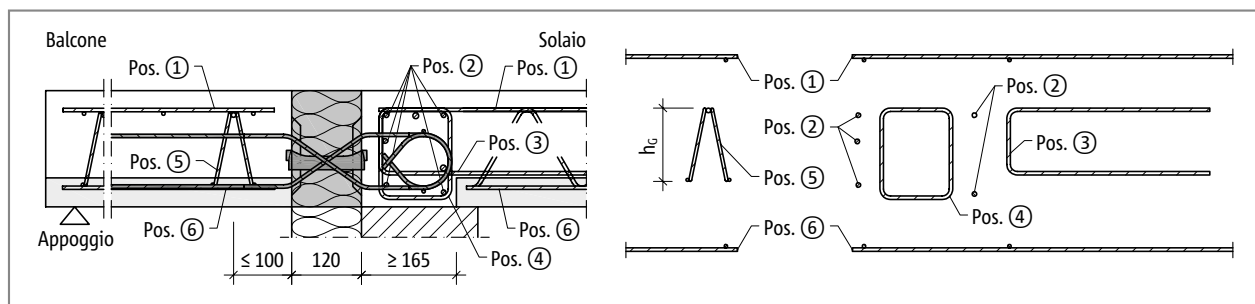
Schöck Isokorb® tipo da QXT10 a QXT40: armatura in opera con reticolo di supporto
